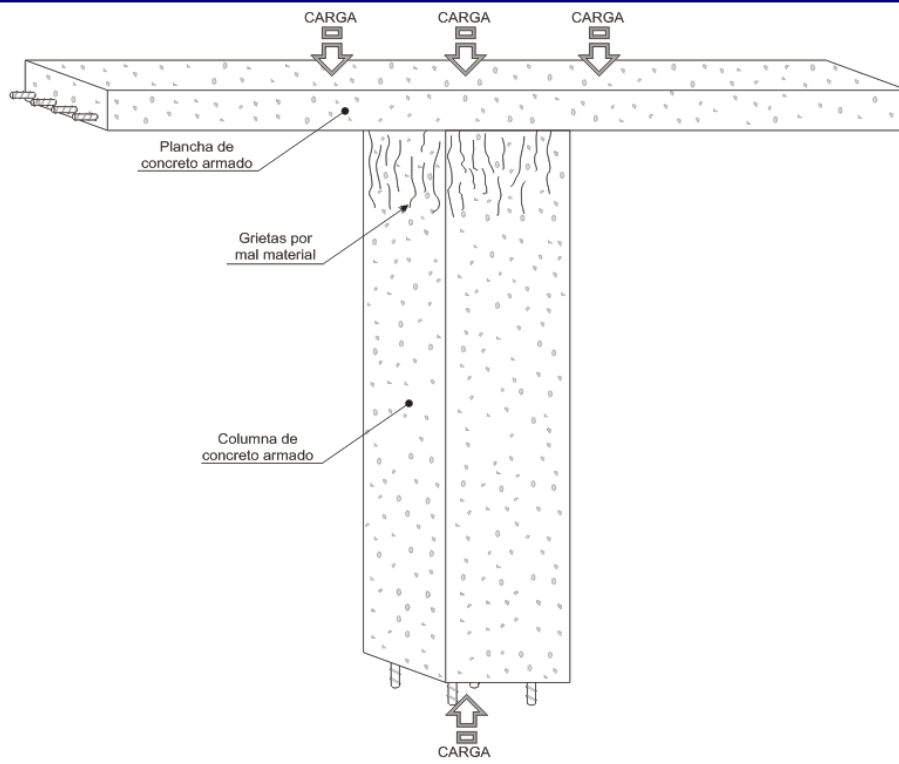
Fisuras sobre columna por concreto de la mala calidad.
